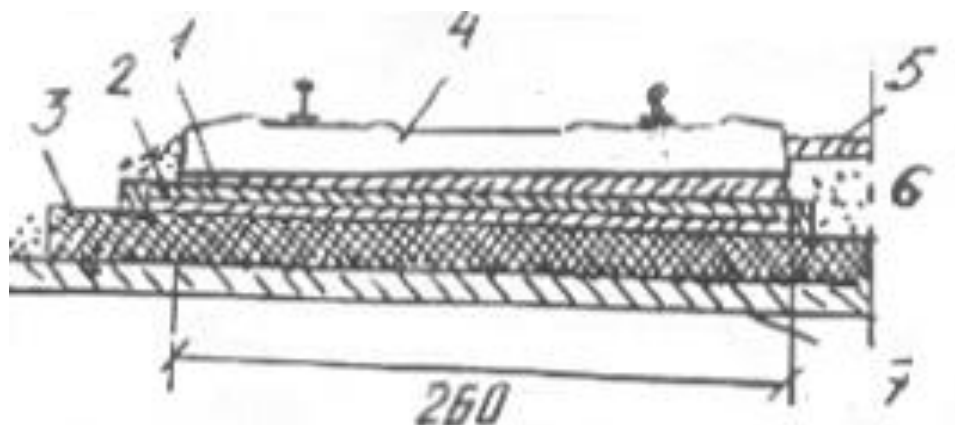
Подрельсовое основание в виде армированной железобетонной плиты с опирающейся на неё рельсошпальной решёткой: 1 – бетон выравнивания и заполнения; 2 – армированная железобетонная плита; 3 – бетон основания; 4 – железобетонная шпала; 5 – битуминизированный гравий; 6 – гравий; 7 - цементация
